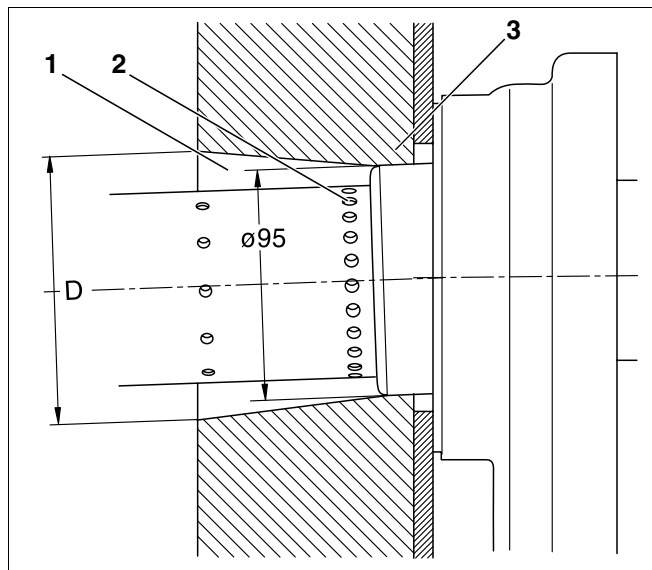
Coupe sur la porte brûleur (dimension en mm)
